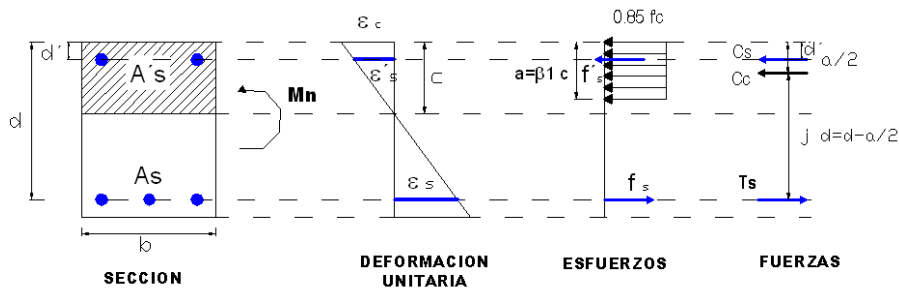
Sección rectangular de concreto simplemente reforzado. Morales (2008:21).
